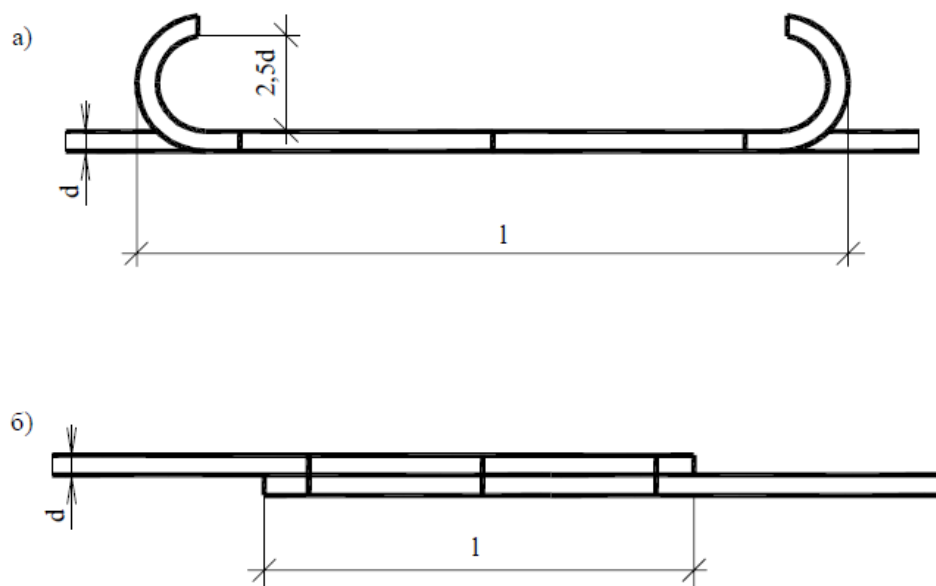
Стыкование арматурных стержней внахлестку путем вязки; а - в растянутой зоне; б - в сжатой зоне
